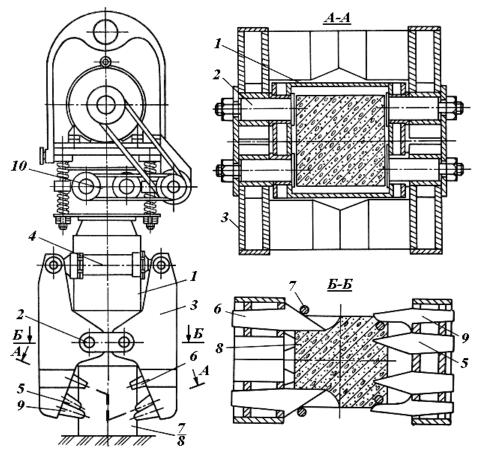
Устройство для срезки свай с сохранением арматуры над срезом
